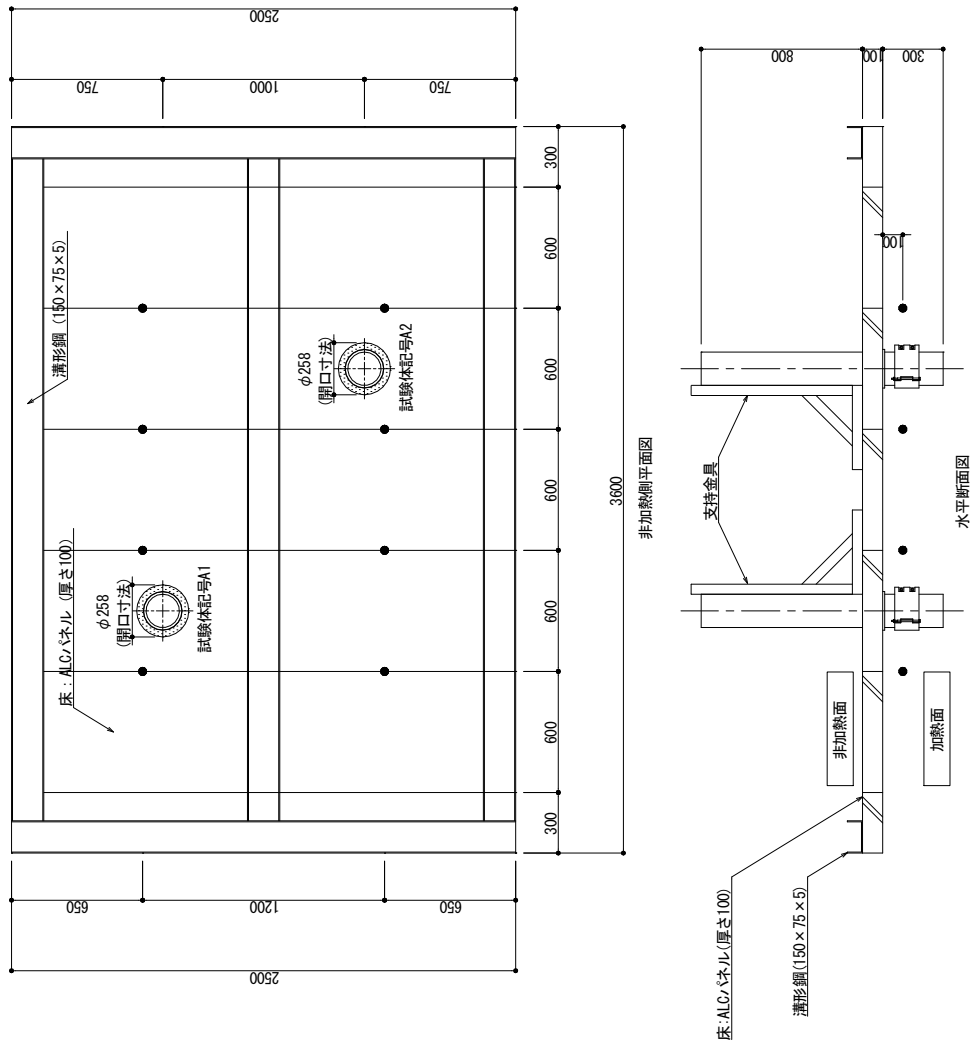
床試験体図(試験体記号 A1 及び A2 配置図、加熱温度測定位置)
